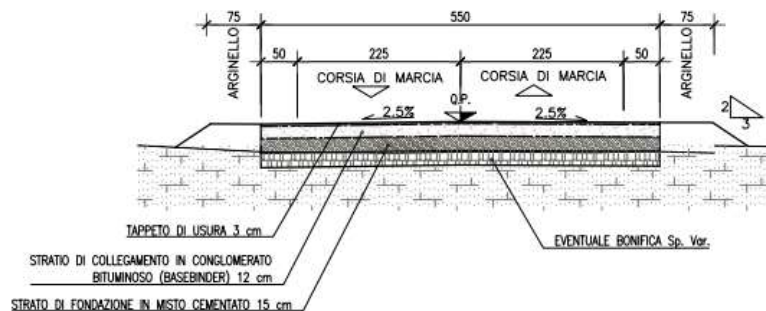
Sezione tipo complanare 5,5 m in rilevato
